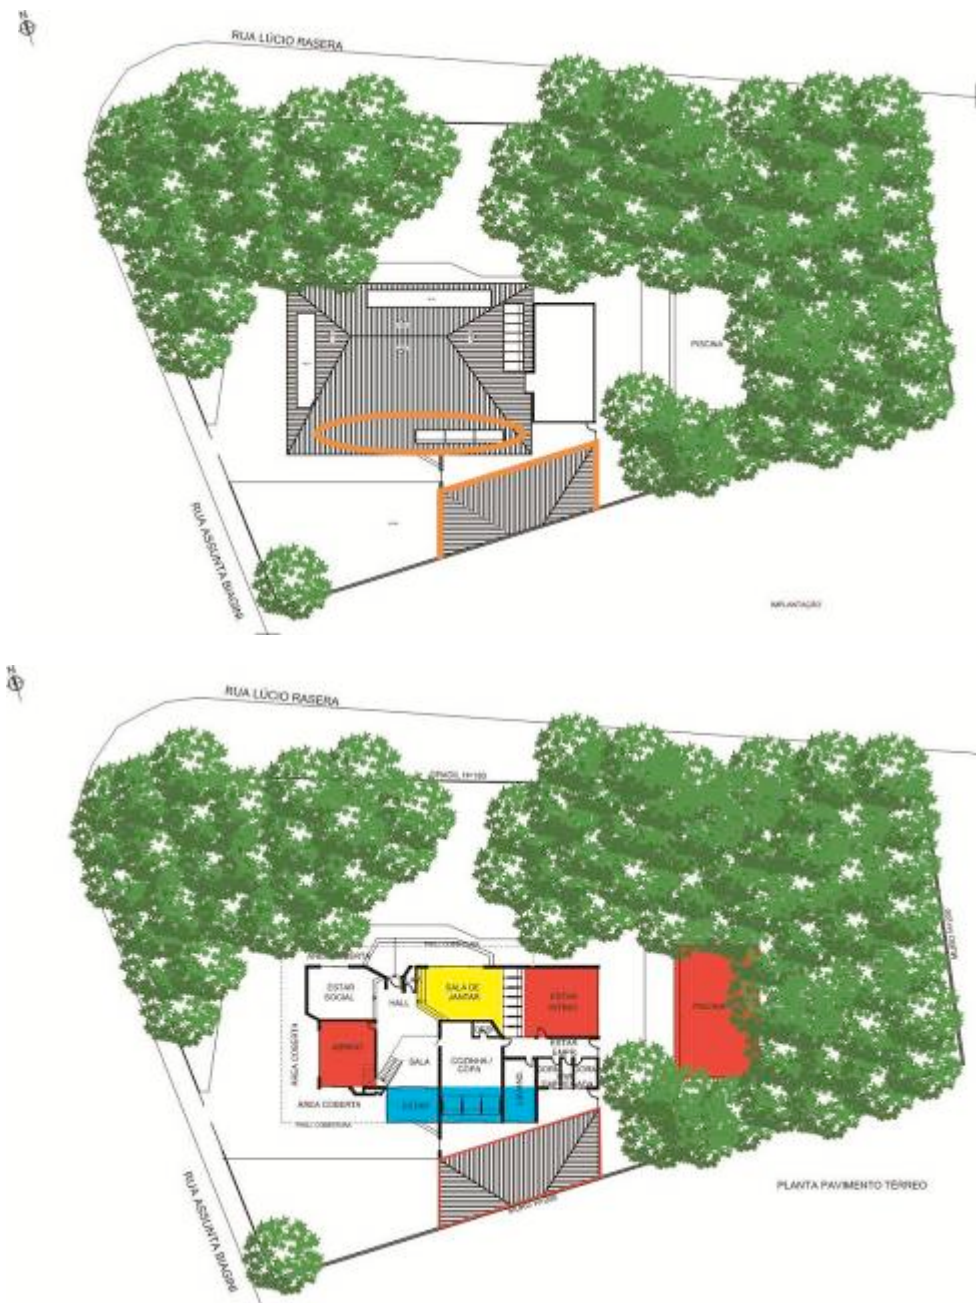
Implantação e Planta Térrea – Modificações do projeto arquitetônico.
